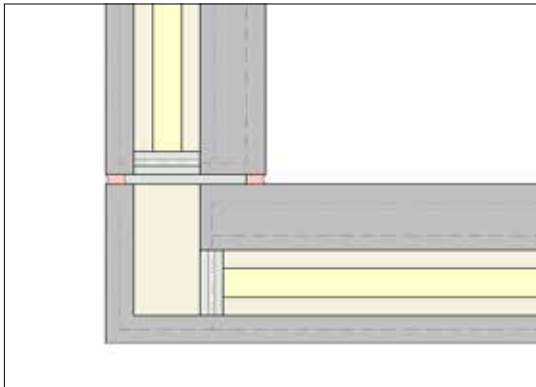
Fassaden-Sandwich-elemente (FSE), Außenecke (kbp)
